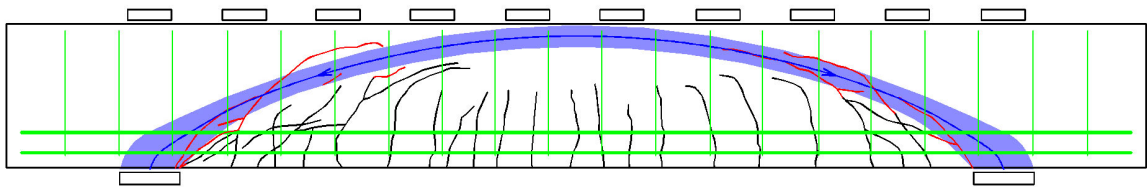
Balken B 3 mit überlagerter Druckparabel und zugehörigen Rissen
